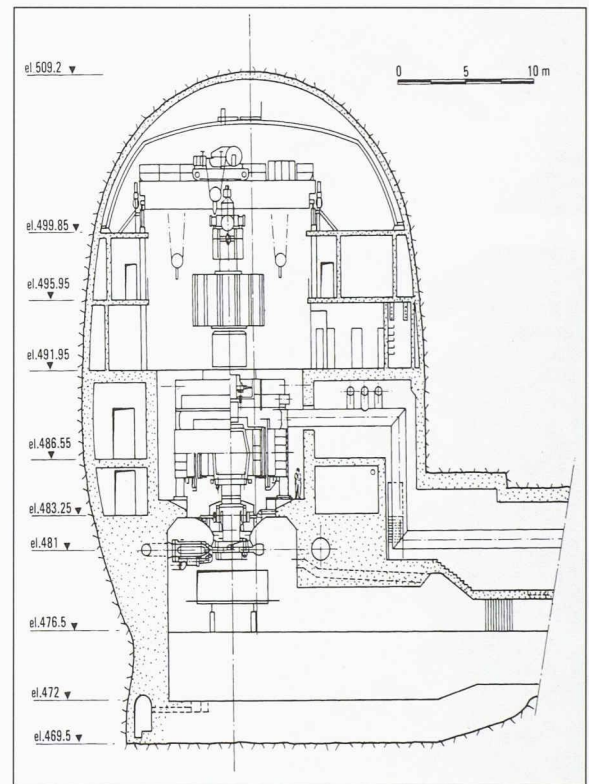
Usine souterraine de Biedron: coupe de la caverne principale abritant la salle des machines
